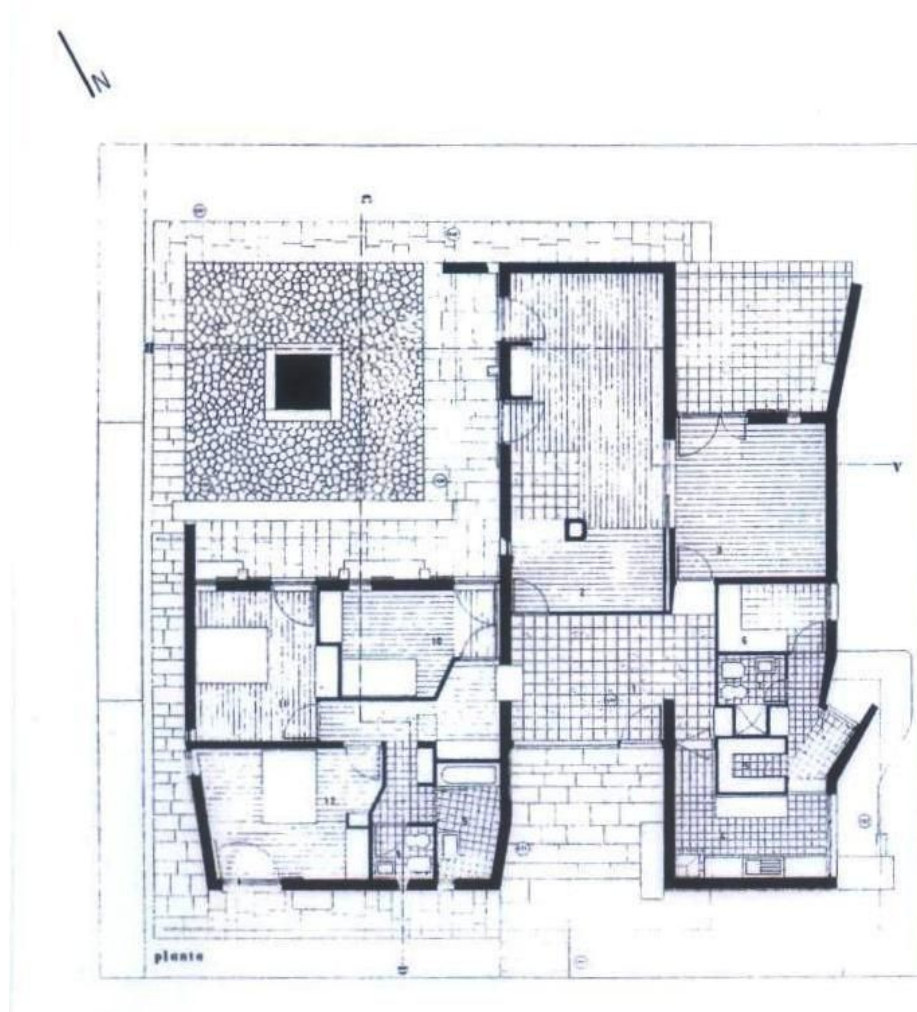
Álvaro Siza Vieira. Planta da casa Carneiro Melo. (1957) Sem Escala.
